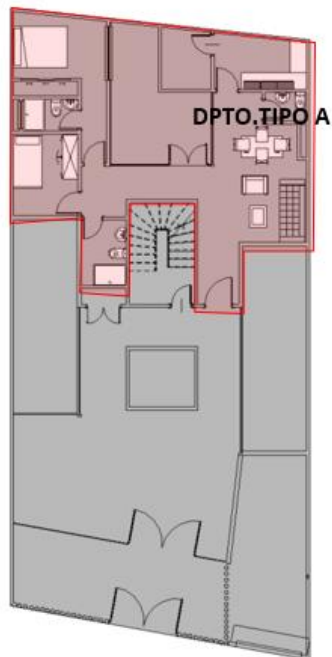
Plano de planta 1 – Dpto. Tipo A.
